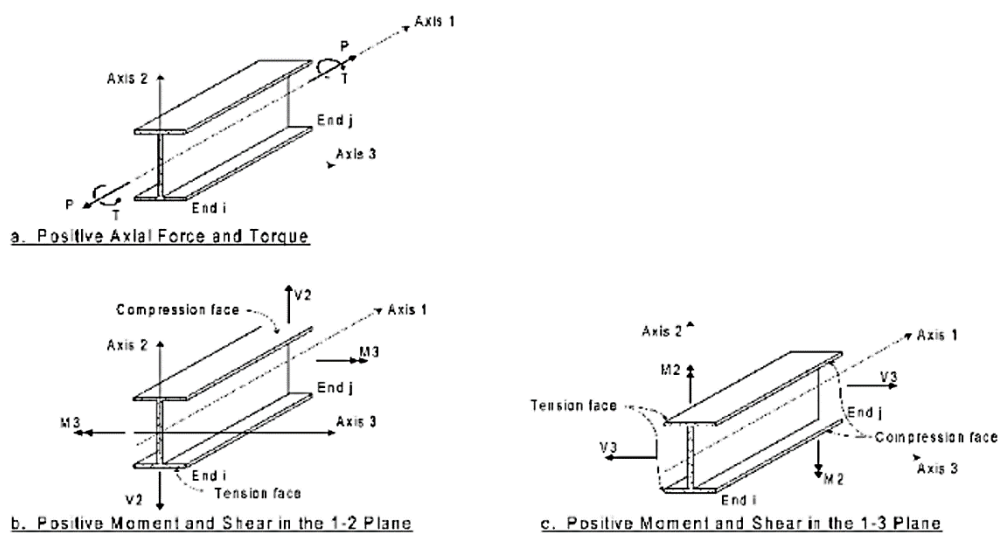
Convención de signos para elementos tipo Frame y Pier en Etabs.
